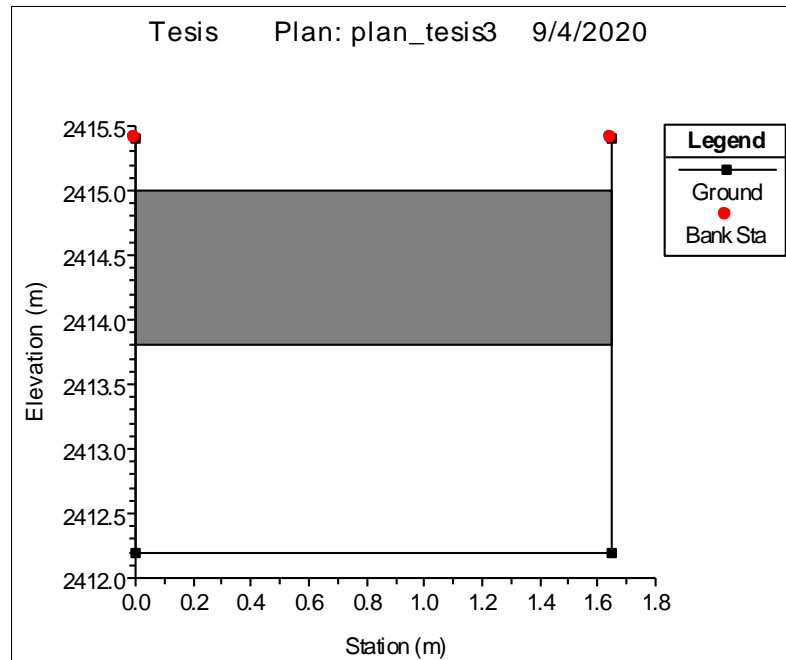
Perfil de alcantarilla en HEC-RAS
